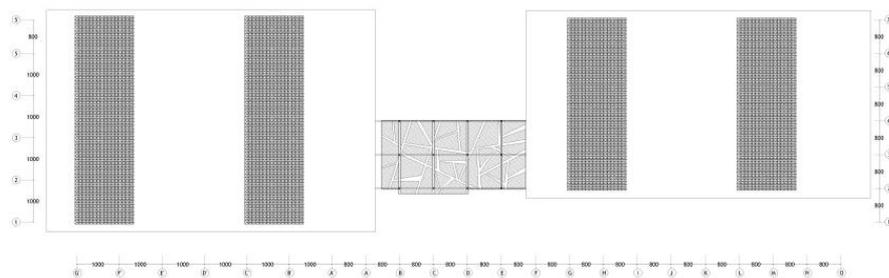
Rencana Pondasi Bangunan Rumah Sakit 1
